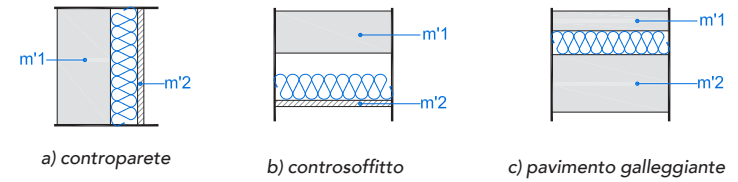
21 - Incremento del potere fonoisolante mediante applicazione di uno strato addizionale (m_2') su strato in muratura (m_1'): a) controparete; b) controsoffitto c) pavimento galleggiante.
